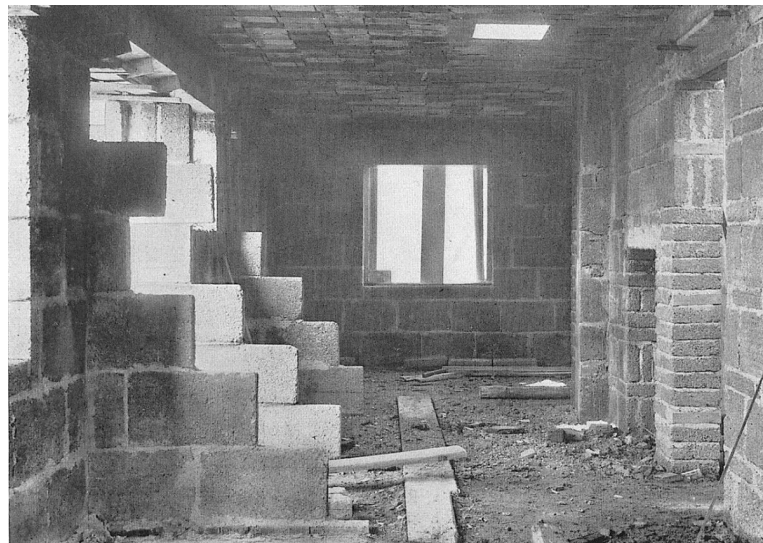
Imagen de la: estructura interior. Casa Experimental de la Bauhaus: Bauhaus Bücher 3, 1925: Bauhausbücher 3.
